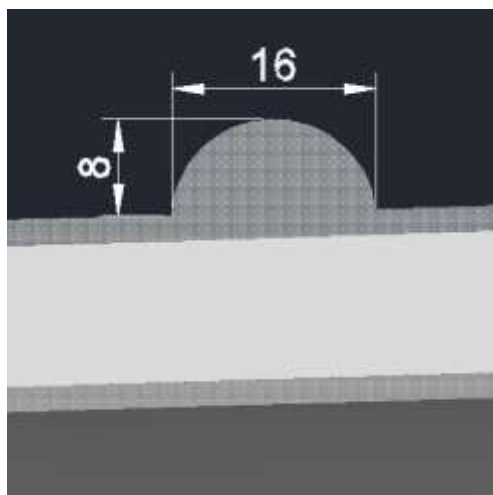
Detalhe do corte do apoio de menor dimensão da telha GePET.
